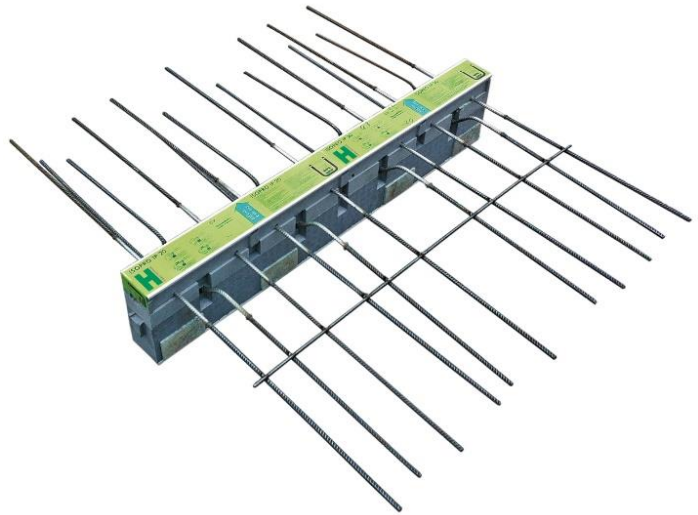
een koudebrug onderbrekende verbinding voor uitkragende balkons, het type K van de fabrikant Schöck
